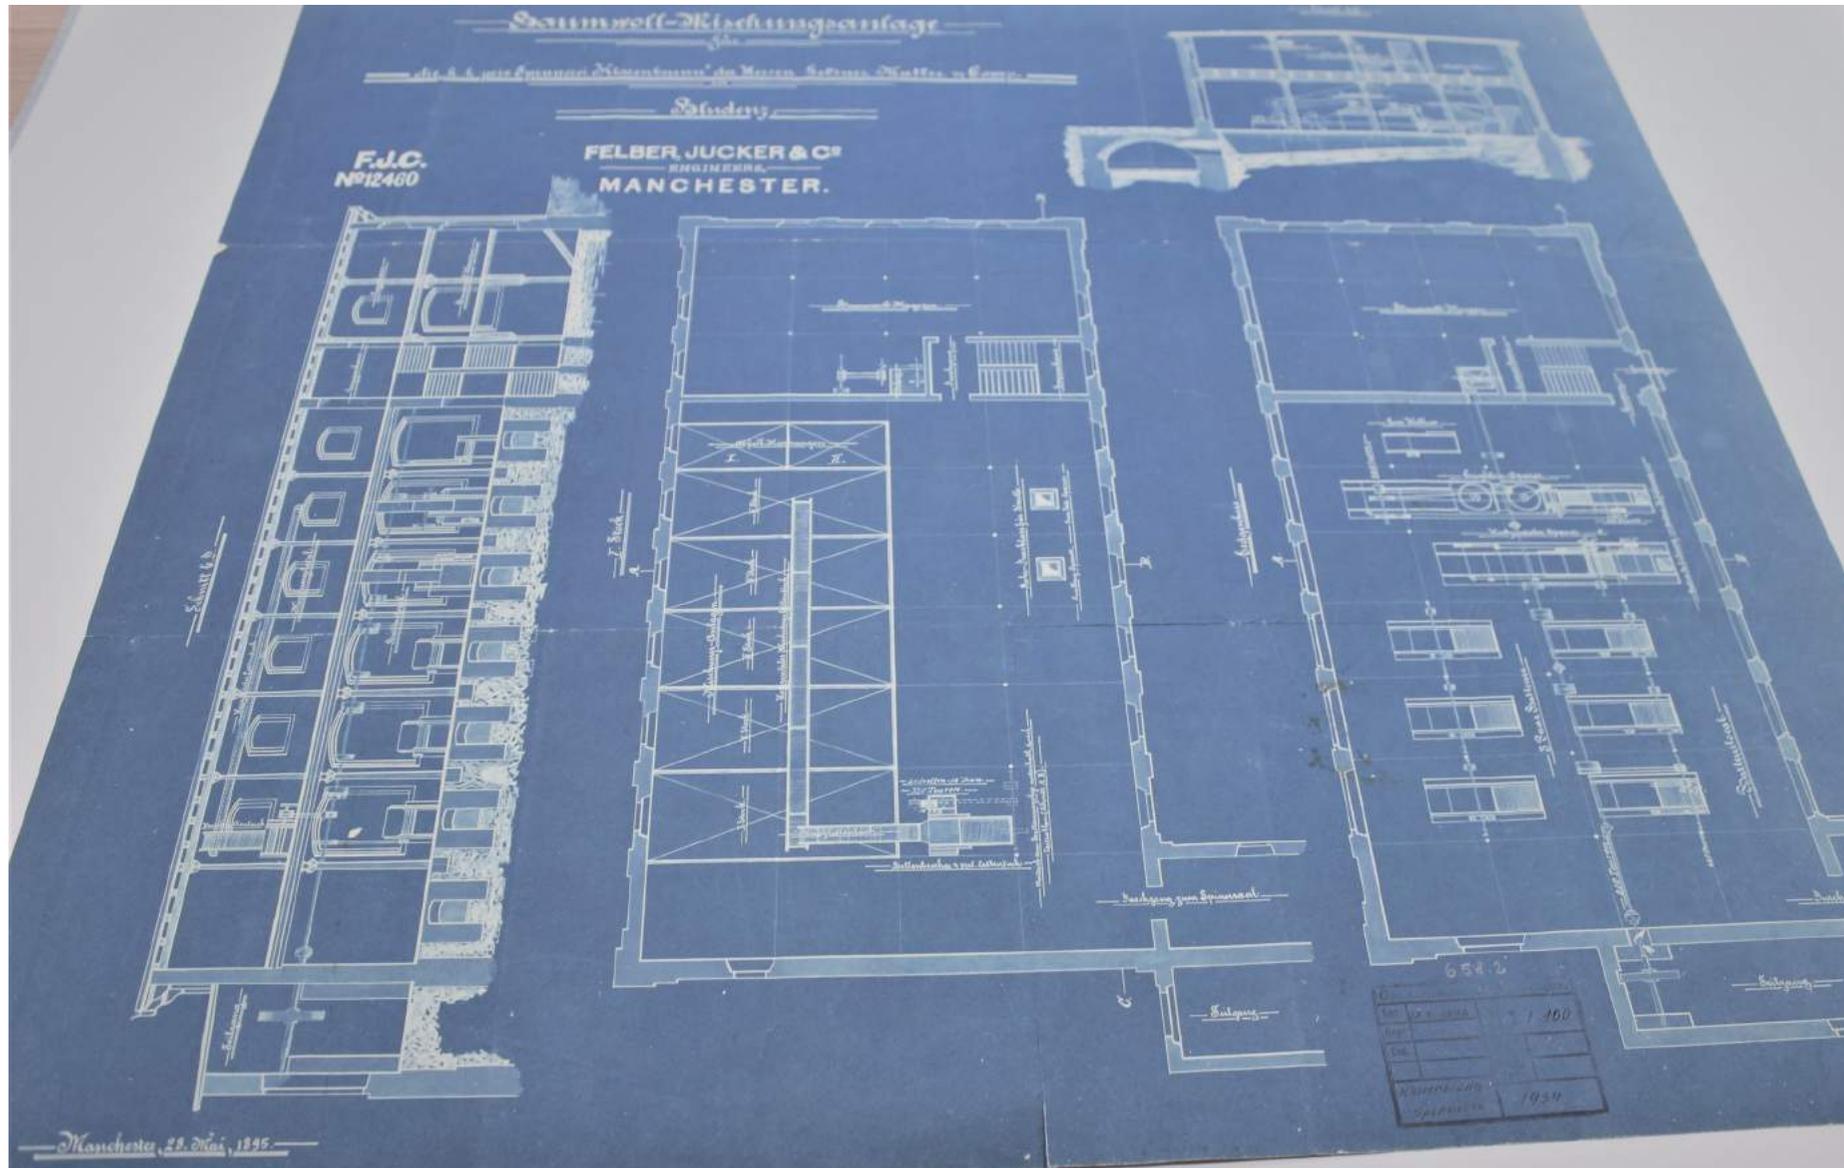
Plan der Putzerei/Mischerei, Neuorganisation der Maschinen, Grundrisse, Längs- und Querschnitt, noch ohne Aufstockung und Stiegenhaus im Inneren, Planverfasser: Felber, Juncker & Co, Engineers, Manchester; Plandatum: 28. Mai 1895
